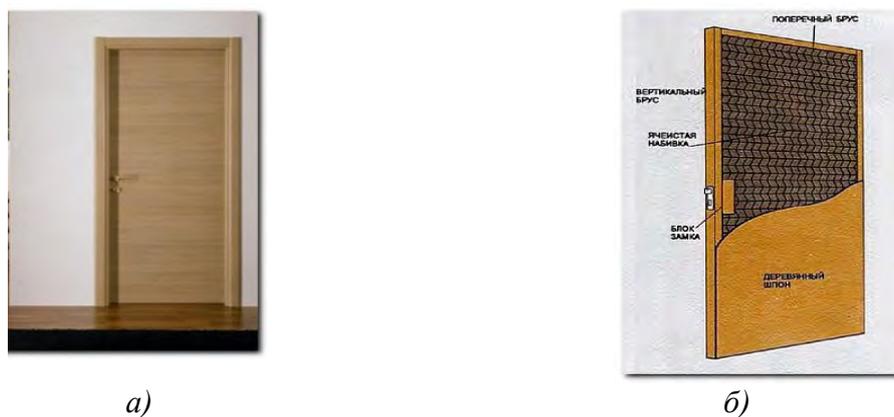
Внешний вид (а) и конструкция (б) щитового дверного блока
